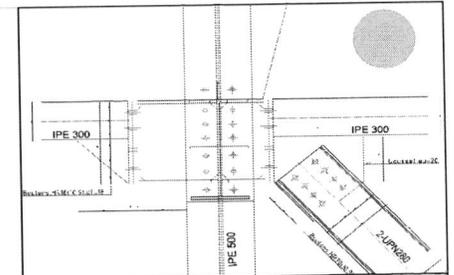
Détail d'assemblage : poteau + contreventement X. ECH 1/20
